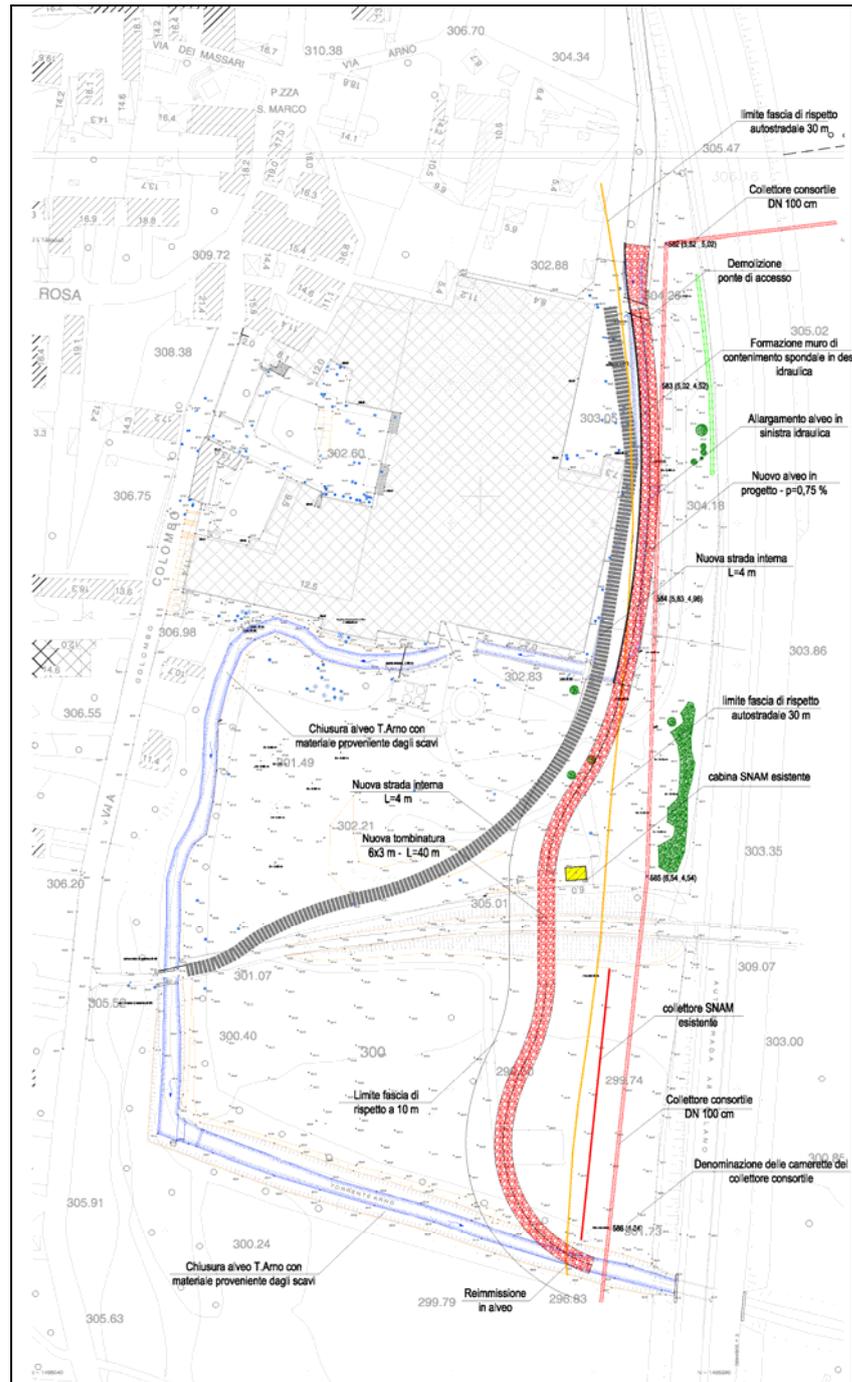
Planimetria con in rosso evidenziata la soluzione dello scenario di progetto
